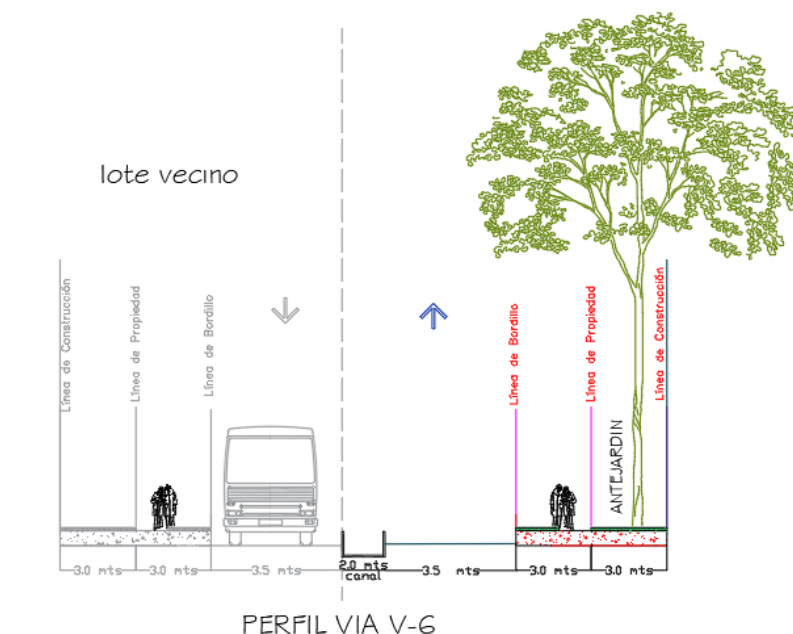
Planta y perfil vial Propuesto (V6 LOCAL)
